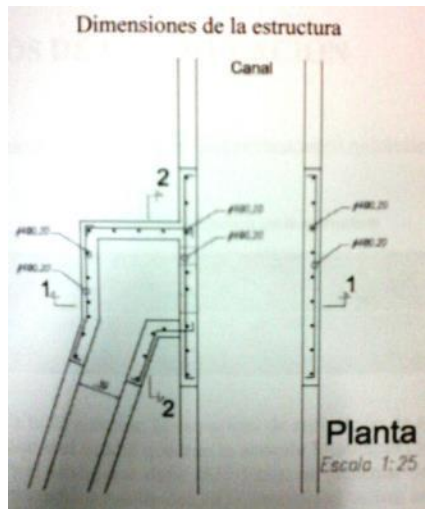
Planta de la obra de reparto a construir para la acequia La Carrilera.
